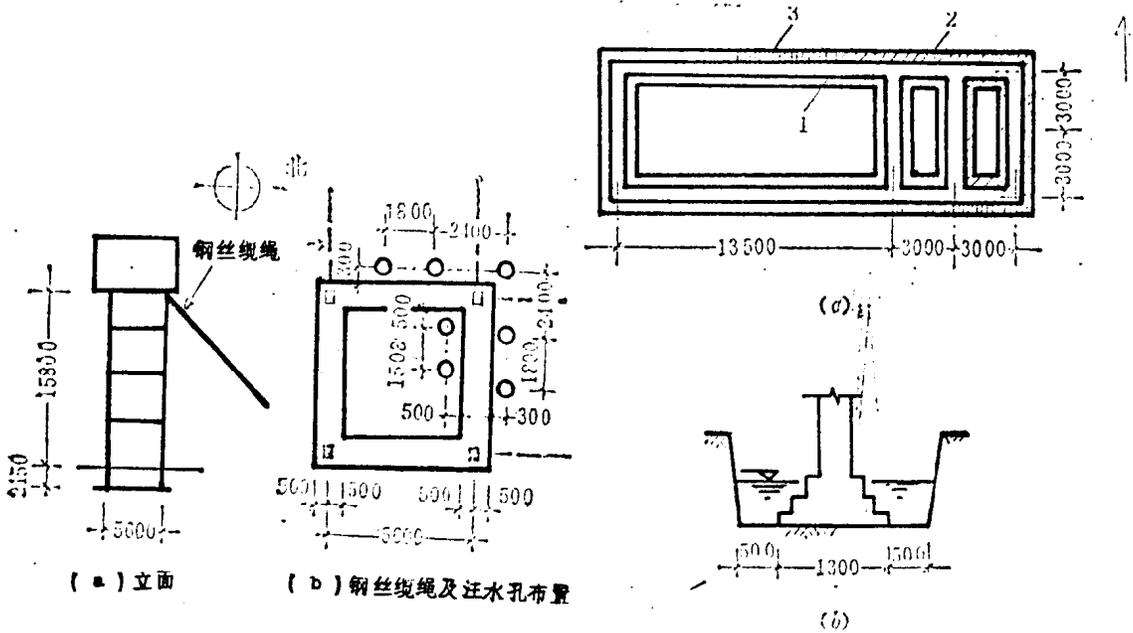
水塔构造及钢丝绳及注水孔平面布置图
